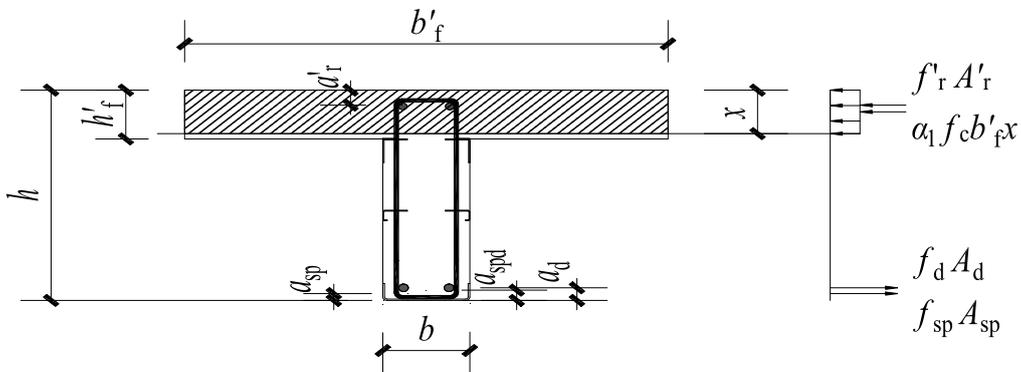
中和轴位于混凝土楼板内时连梁受弯承载力计算参数示意图
